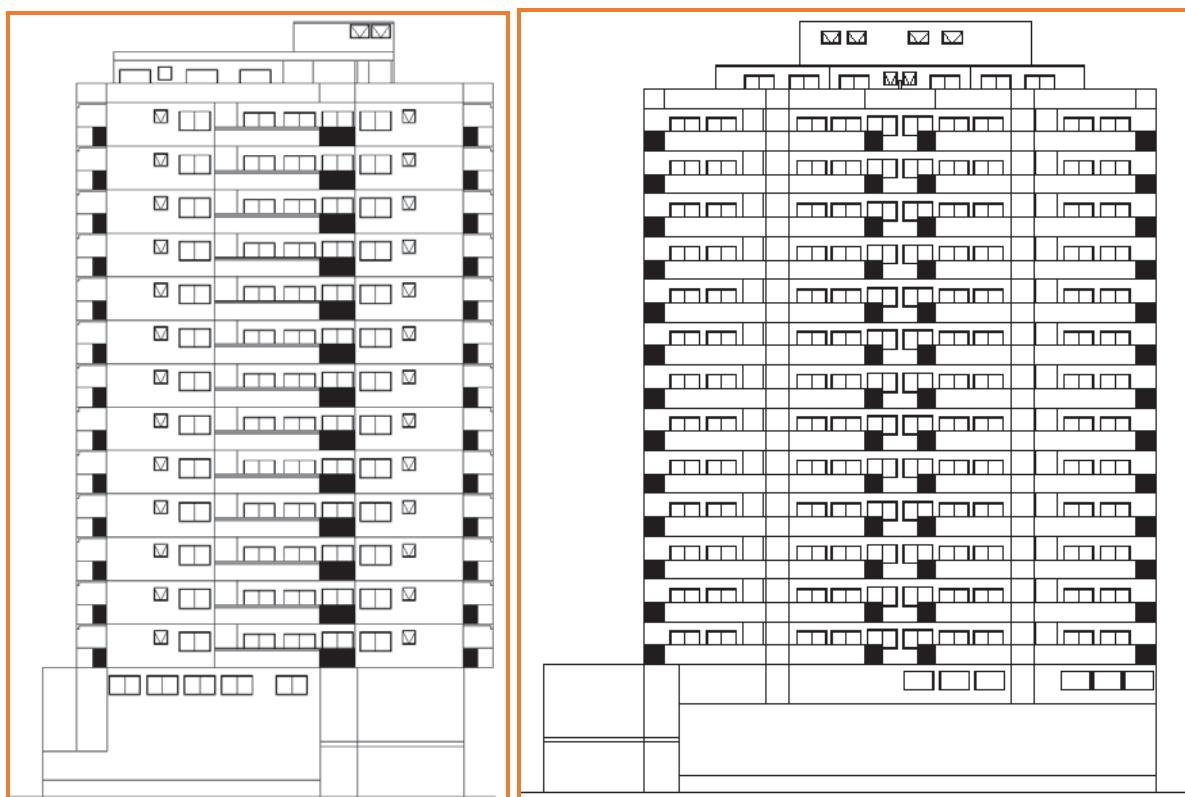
Fachada do prédio para a Rua Dr. Mario Vianna e Travessa Paula Antunes.
